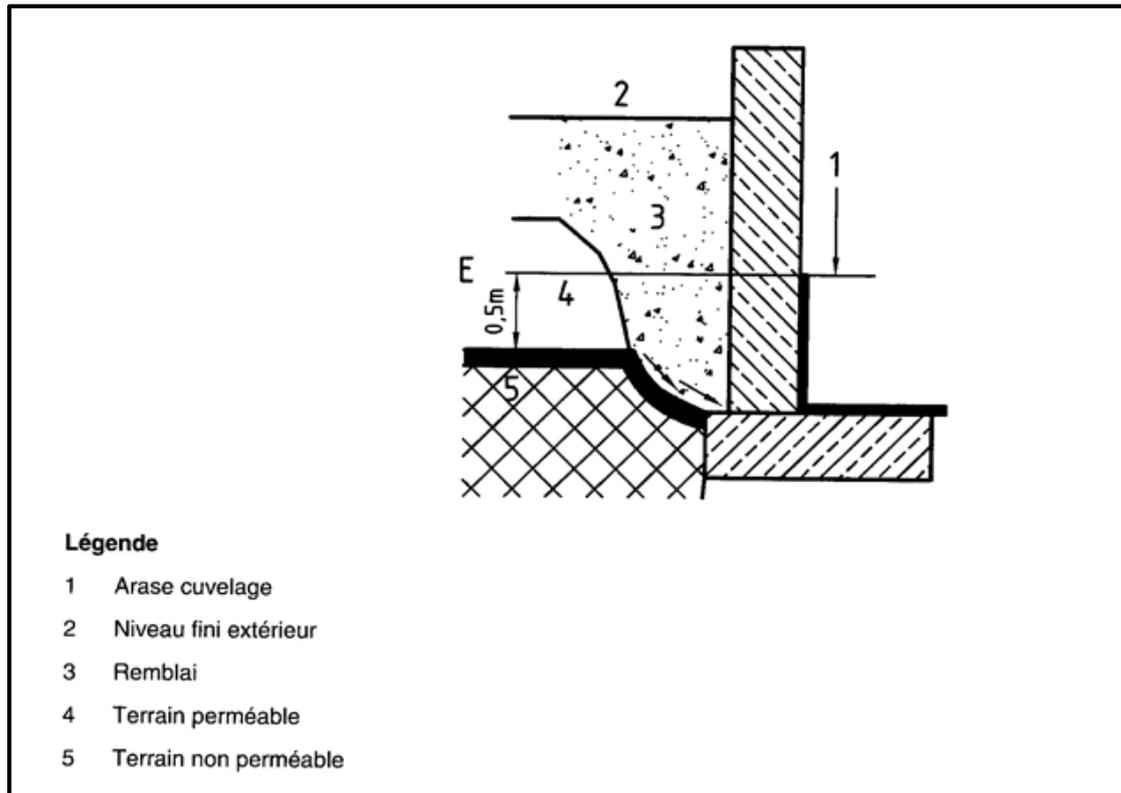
Exemple de cas d'eaux de ruissellement ou d'infiltration sans drainage
